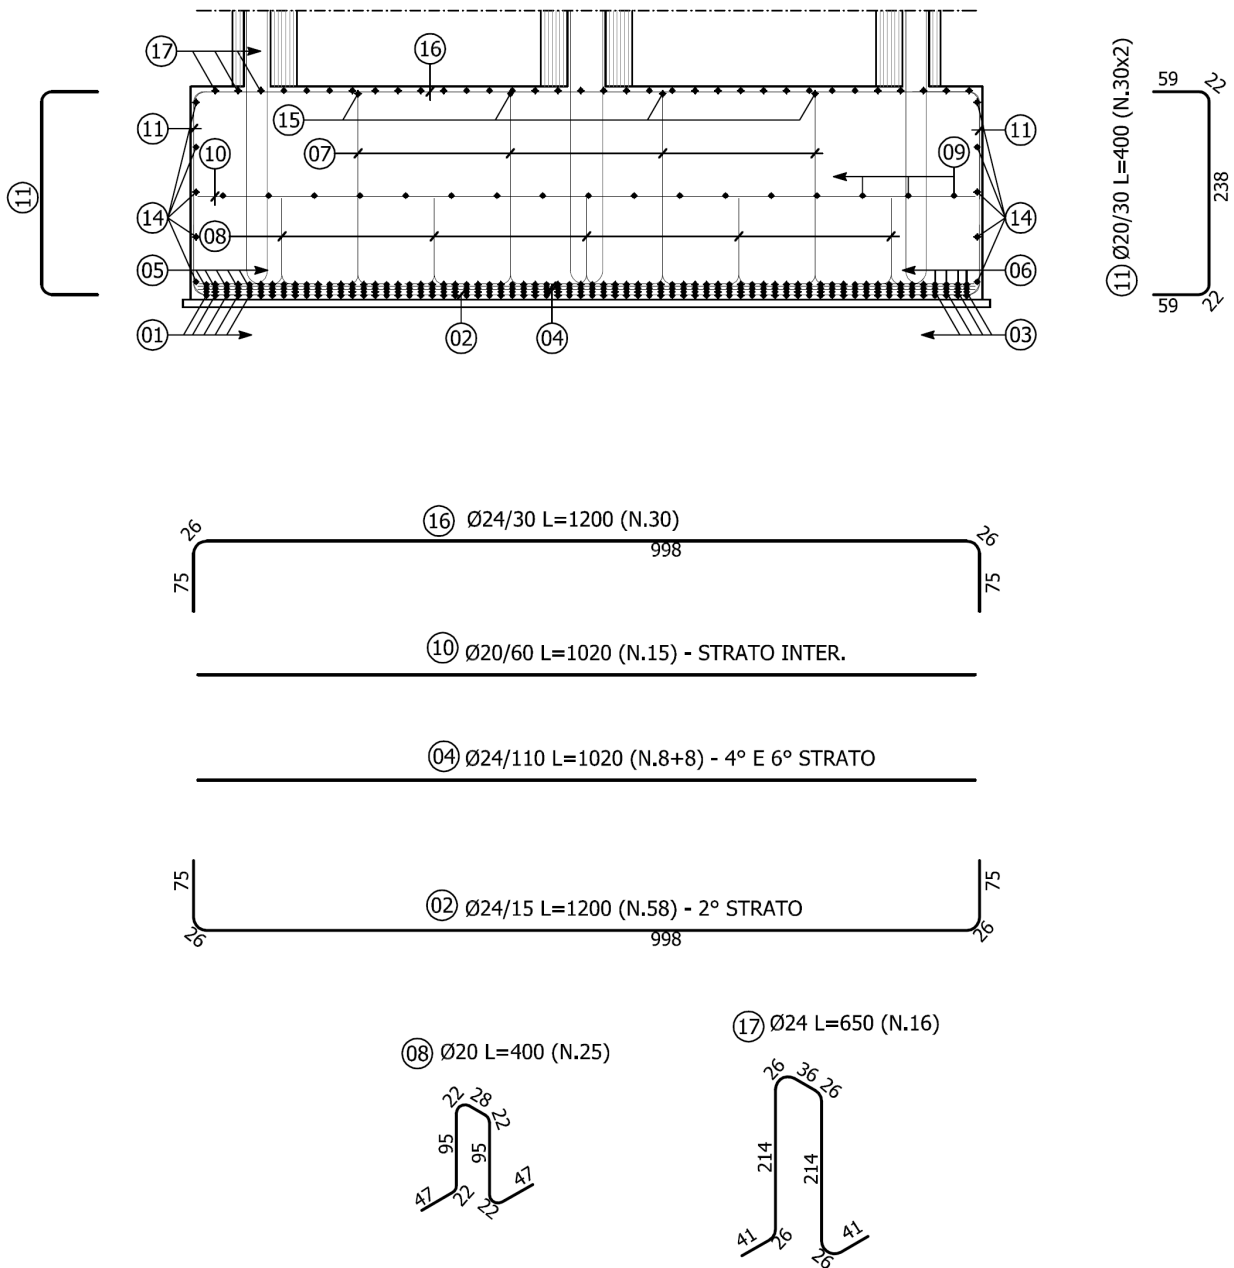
Armatura della fondazione della pila: sezione trasversale
